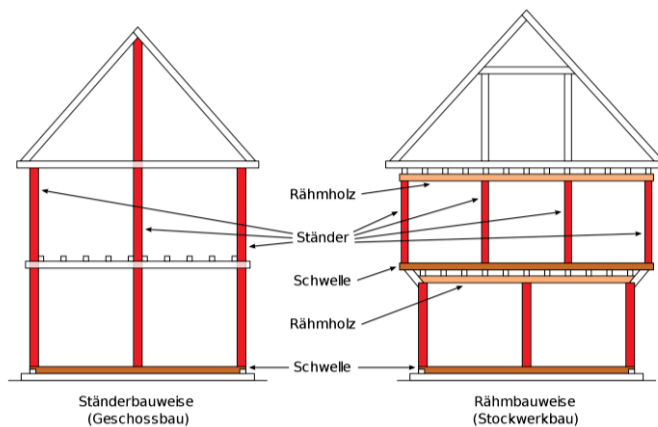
Vergleich Geschossbauweise (links) zur Stockbauweise (rechts)<sup>12</sup>
